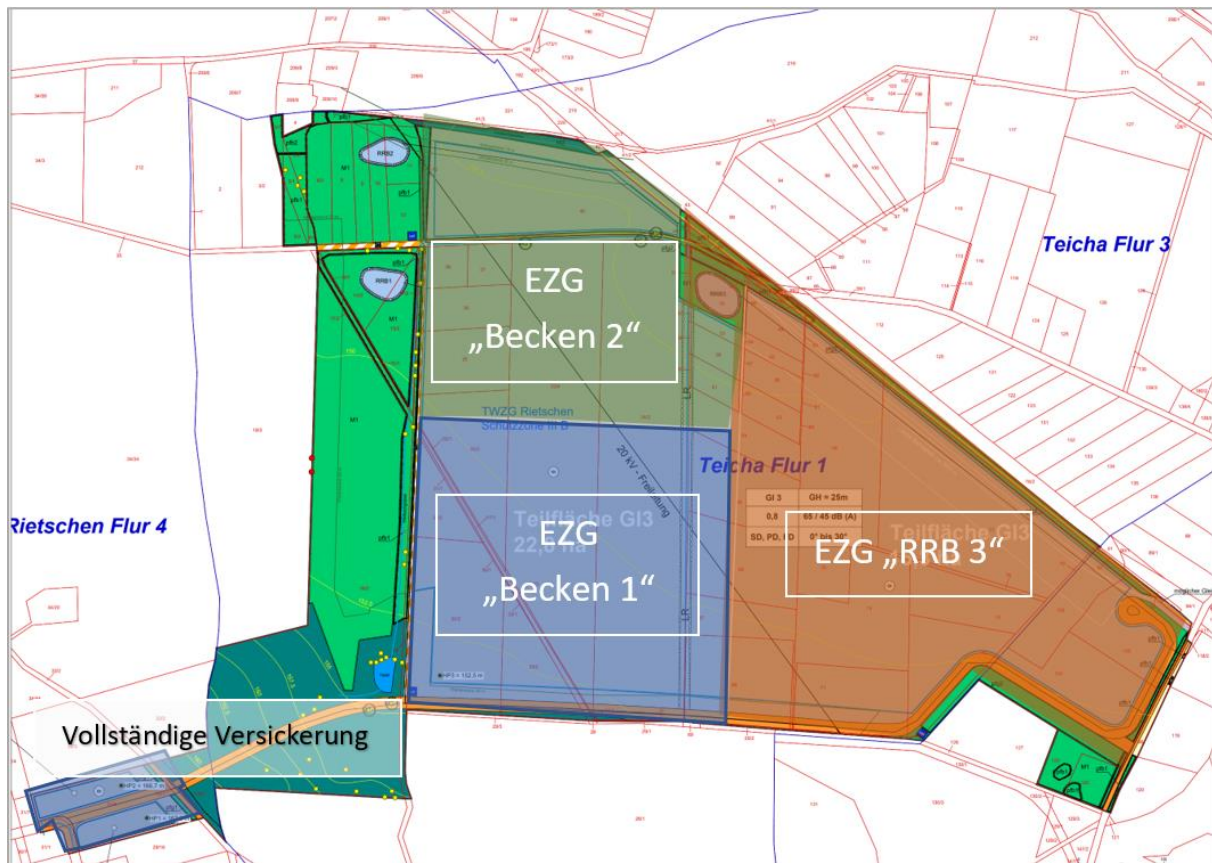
Darstellung der Einzugsgebiete für die geplanten Regenrückhalte- und Versickerungsbecken, Stand: 30.08.2024
